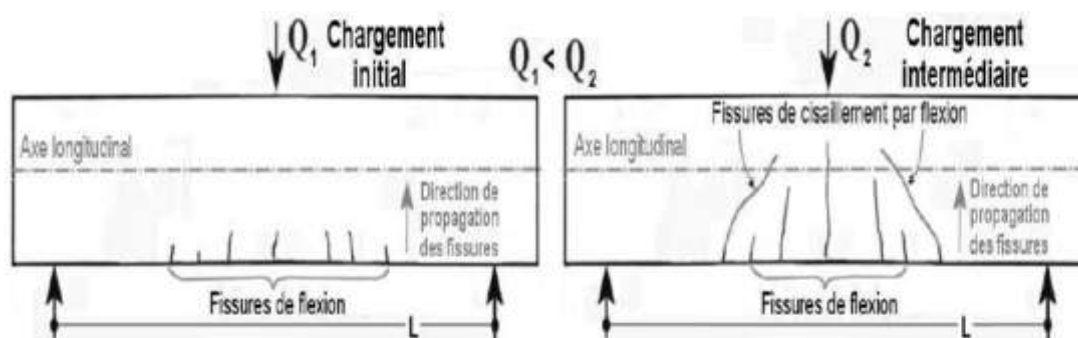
I.1: Représentation de la fissuration initiale et intermédiaire par flexion d'une poutre en béton armé (BA) [8].
